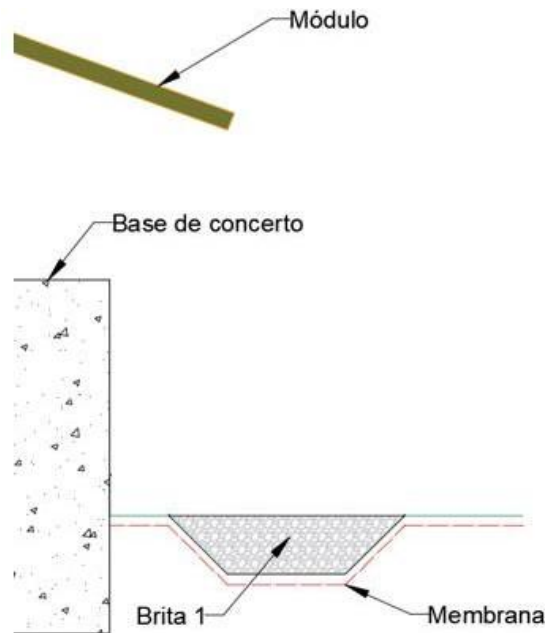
Esquema construtivo de calhas para drenagem de água pluvial do plano dos módulos FV
